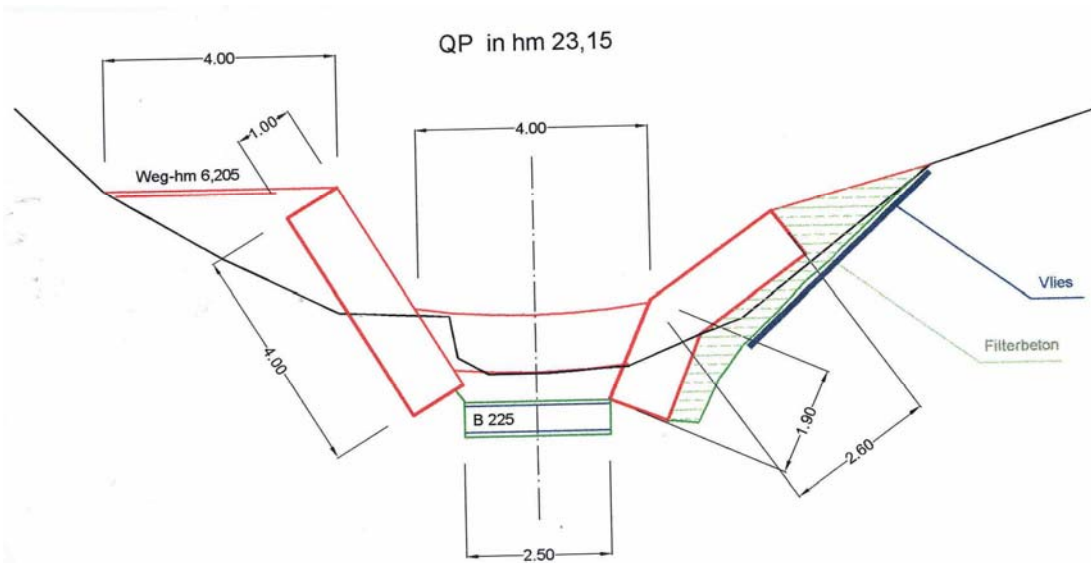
Querprofil durch ein Rampenbauwerk und Uferdeckwerk im Seeton
